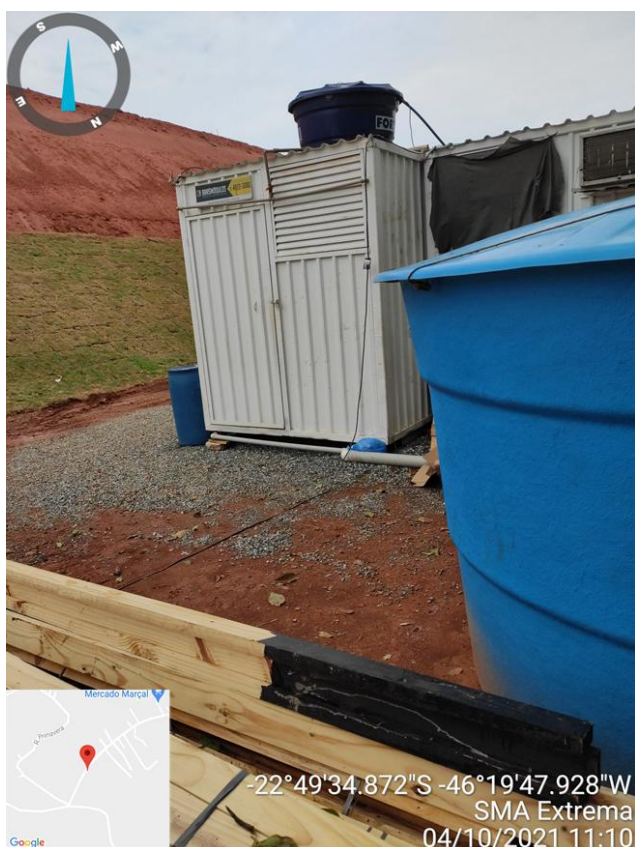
Instalações Sanitárias do Canteiro de Obras 2
